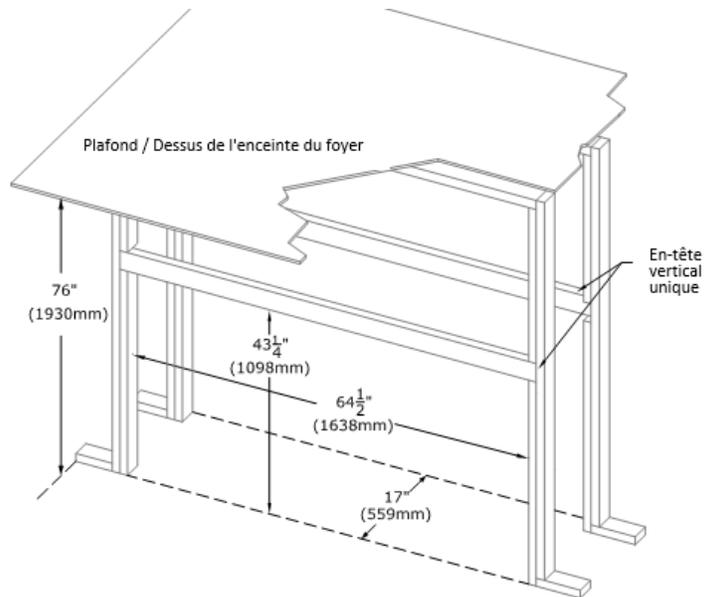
Encadrement et dégagement pour le foyer Callaway See Thru
